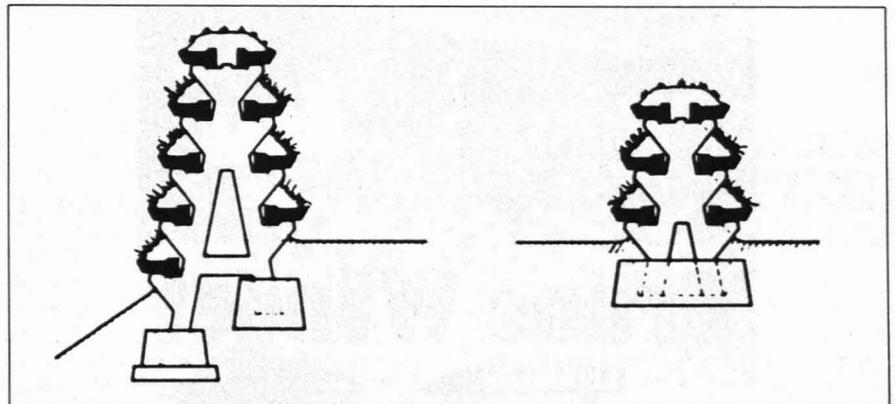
Steilwall System »Multimauer« (Ausführungsbeispiele)
